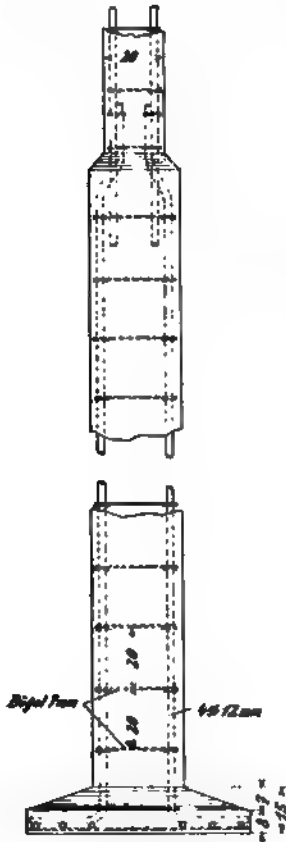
Übergang einer dünneren Eisensäule in einer stärkeren.
